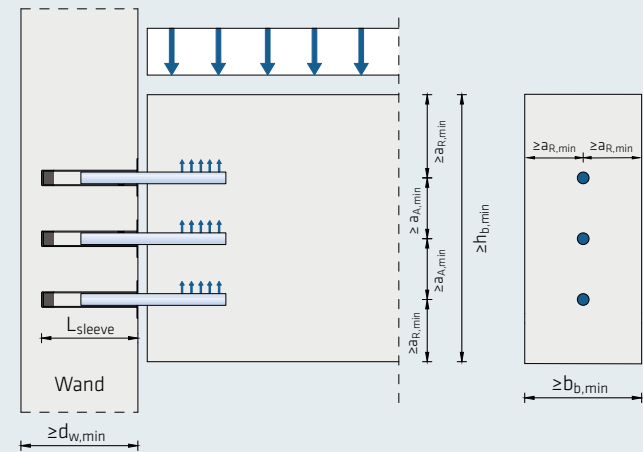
Defintion Abmessungen Anschluss Balken - Wand
